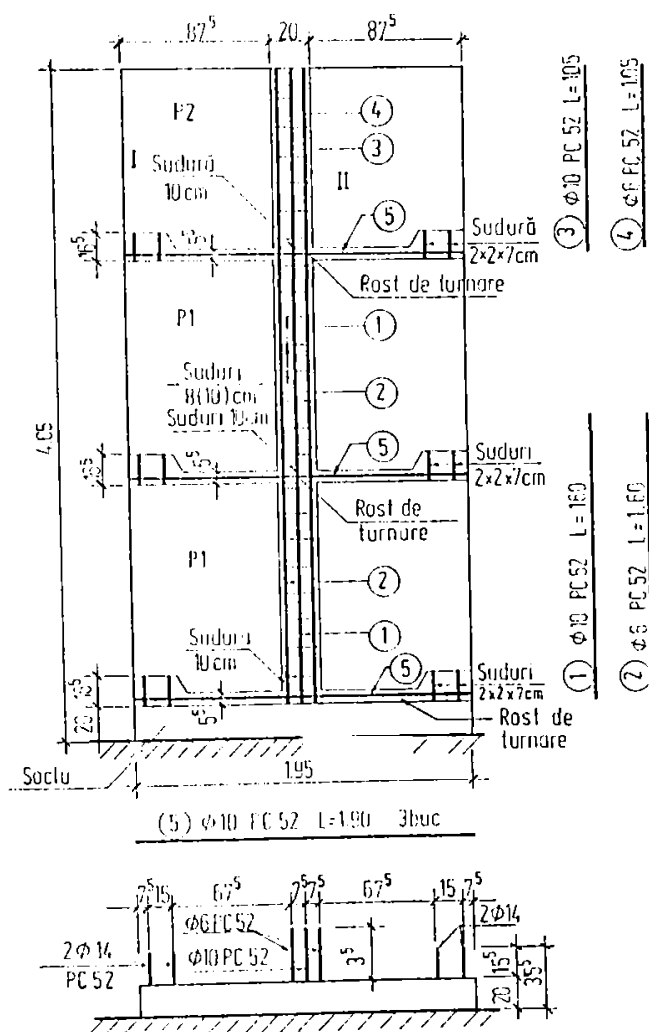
PERETE STRUCTURAL PREFABRICAT - MODEL F5-ARMAREA ÎMBINĂRILOR
